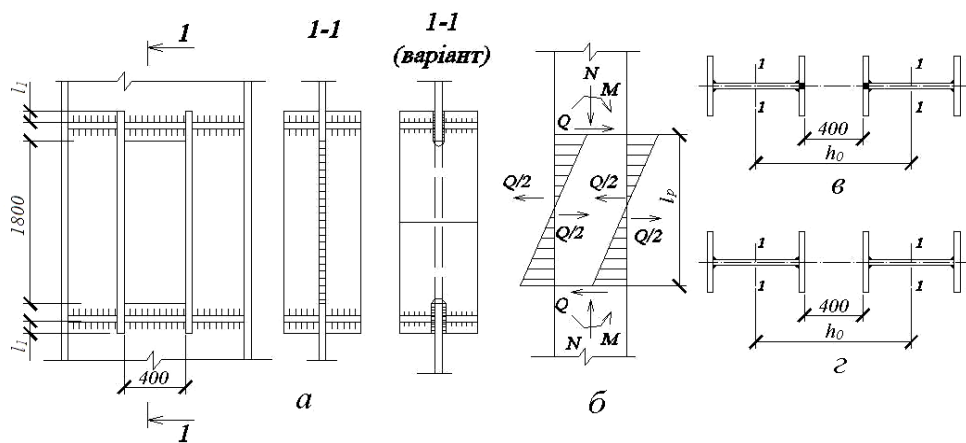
Проріз для проходу в колоні: а – конструктивне рішення; б – розрахункова схема; в, з – варіанти укріплення вертикальними ребрами; 1 – зварний шов у вертикальному ребрі
